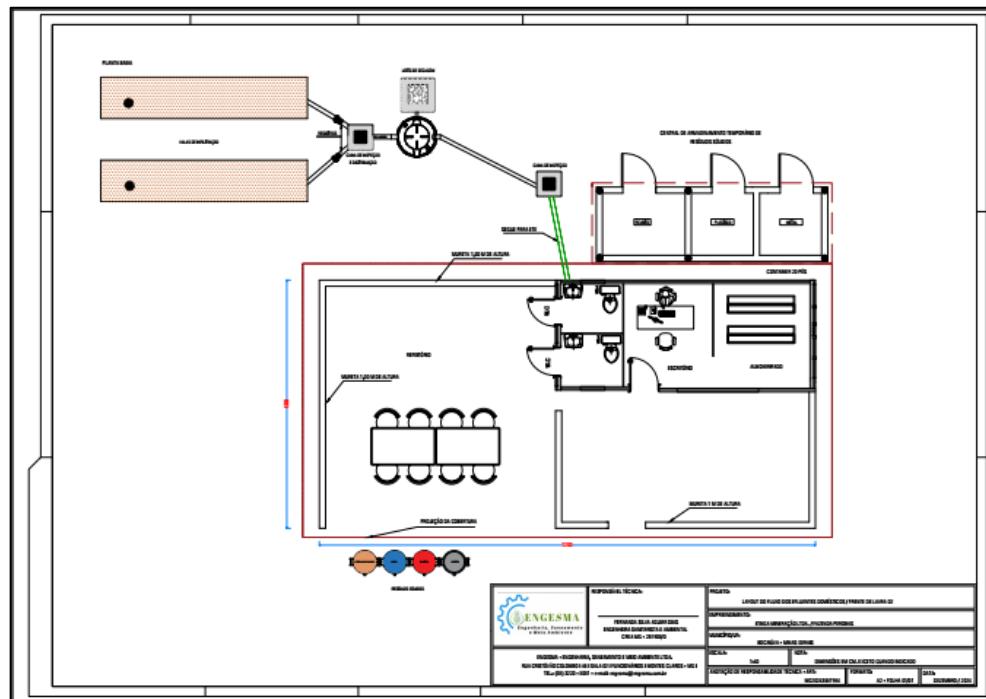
Planta baixa da área de apoio da frente de lavra-2 e ETE.
